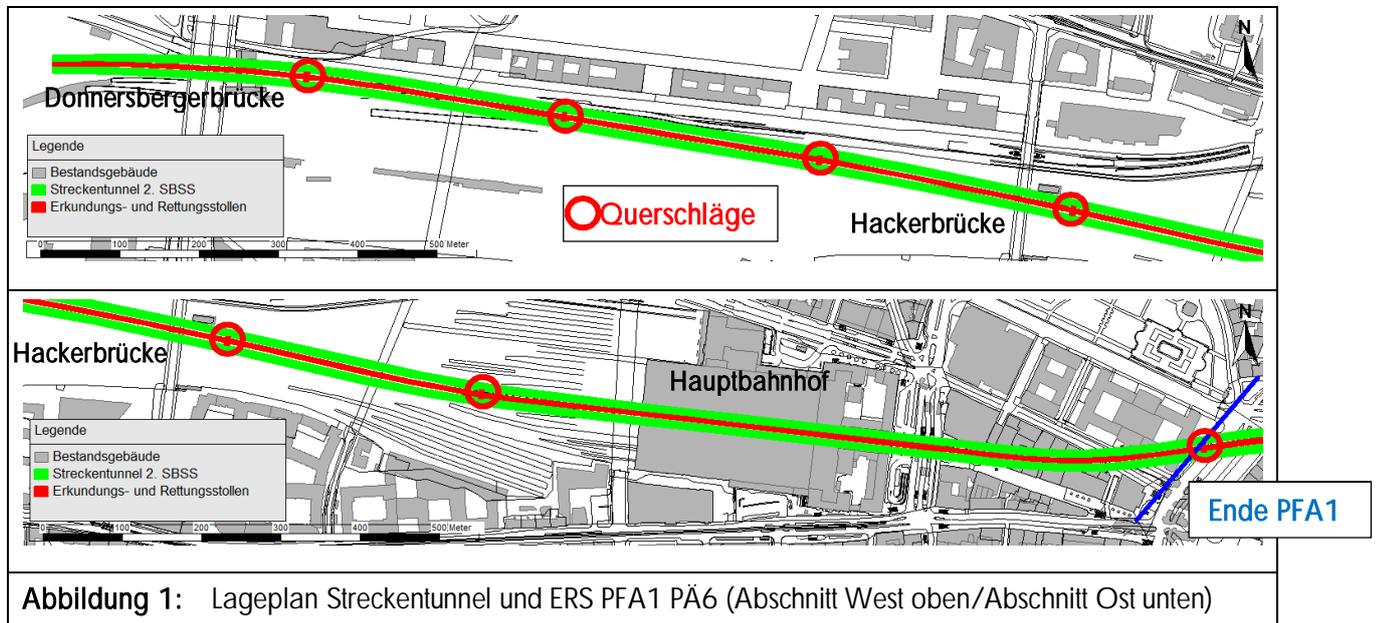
Lageplan Streckentunnel und ERS PFA1 PÄ6 (Abschnitt West oben/Abschnitt Ost unten)
